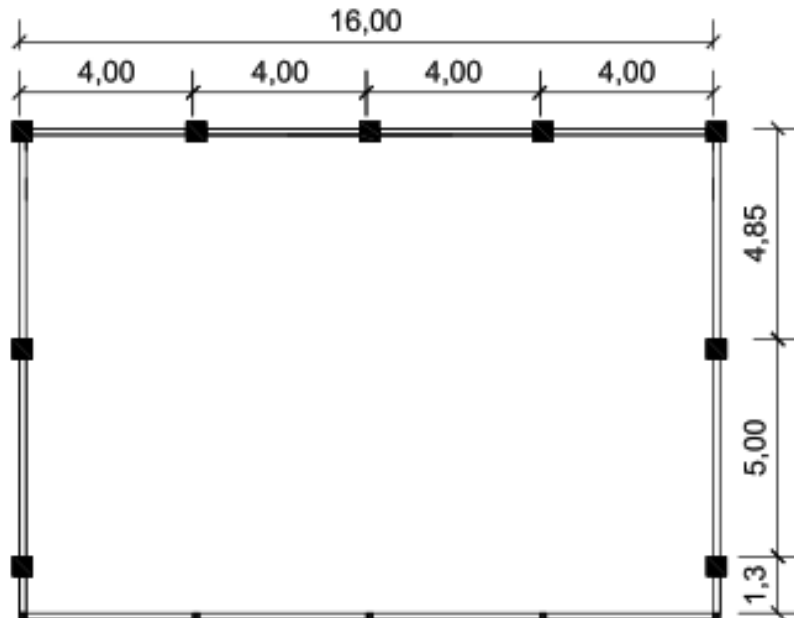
Denah lantai 1 Gedung Wisma Mulya Syariah
